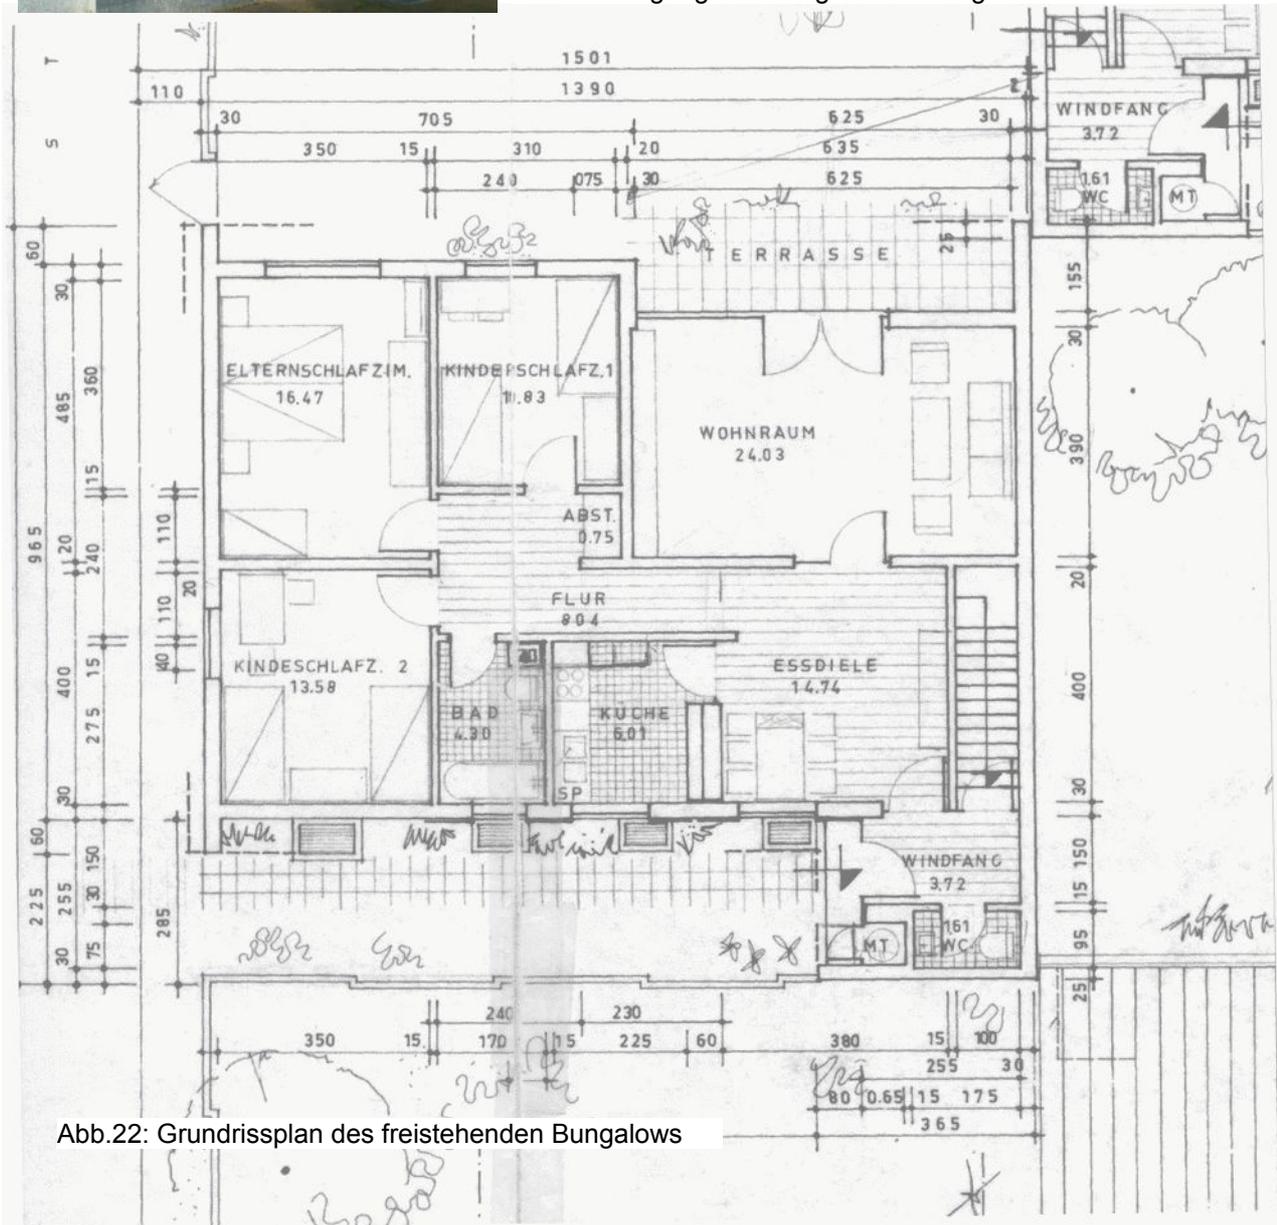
Grundrissplan des freistehenden Bungalows
